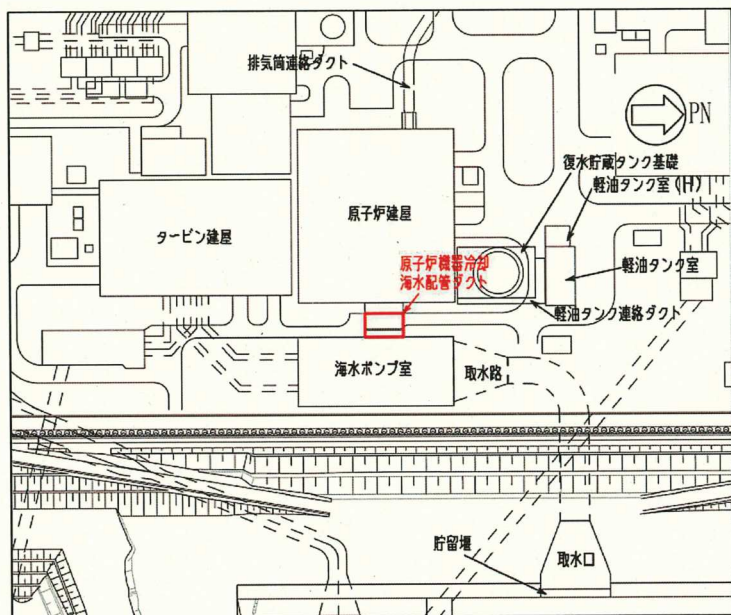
原子炉機器冷却海水配管ダクト配置図
